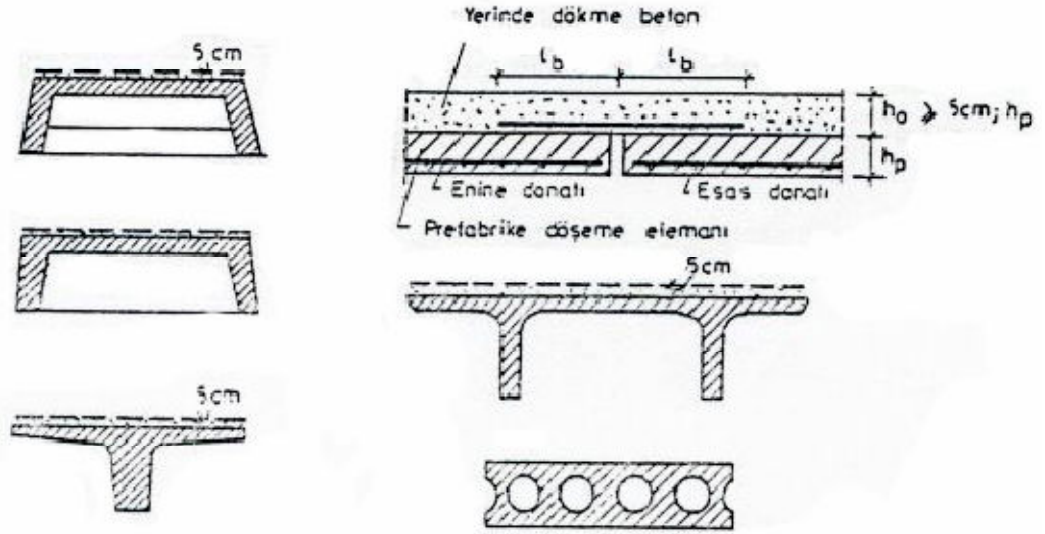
Prefabrik Döşemelerin Kirişe Bağlanması
